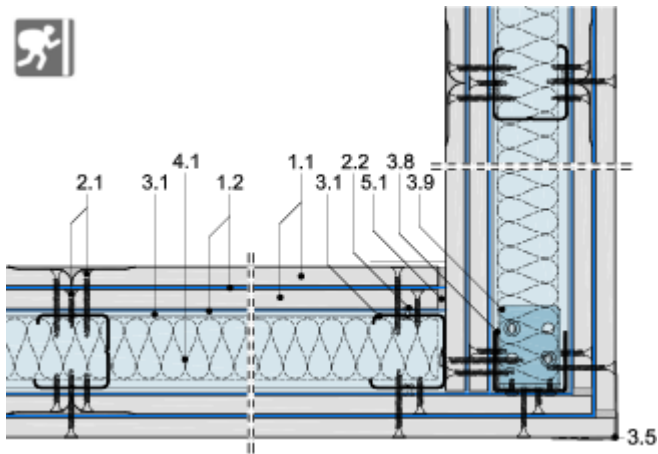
Wandanschluss Doppelständerwand RC 3 mit erhöhtem Schallschutz
